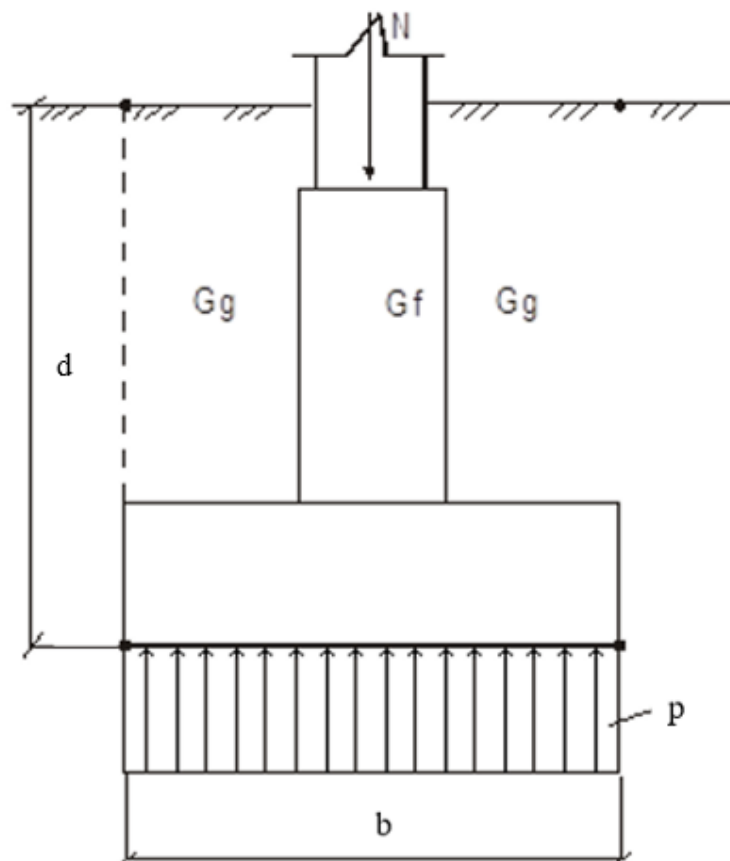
До визначення ширини підшви фундаменту: N – зосереджена сила; A – площа підшви фундаменту, G_f – навантаження від власної ваги фундаменту; G_g – навантаження від ваги ґрунту на його уступах; p – тиск під підшовою фундаменту; d – глибина закладання фундаменту
